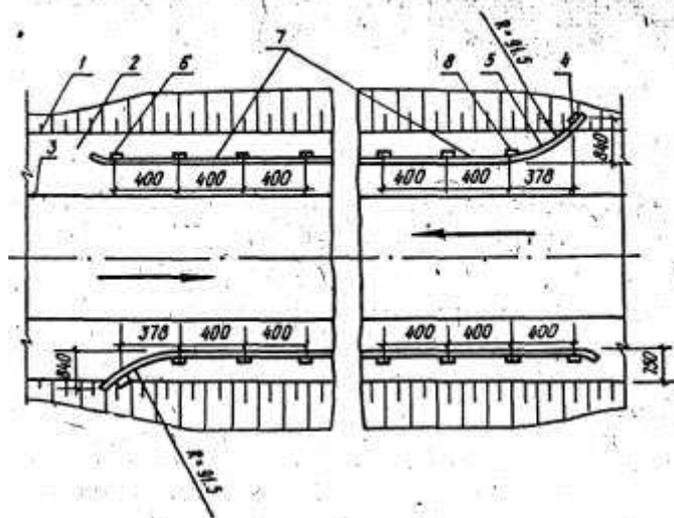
Схема расположения барьерного ограждения из стального бруса на насыпи высотой более 3 м:
